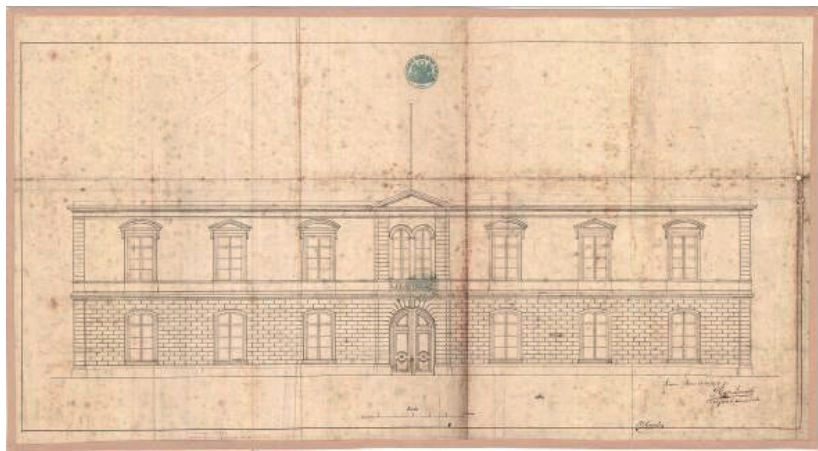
Plano de la fachada del patio de maestros (1873).
